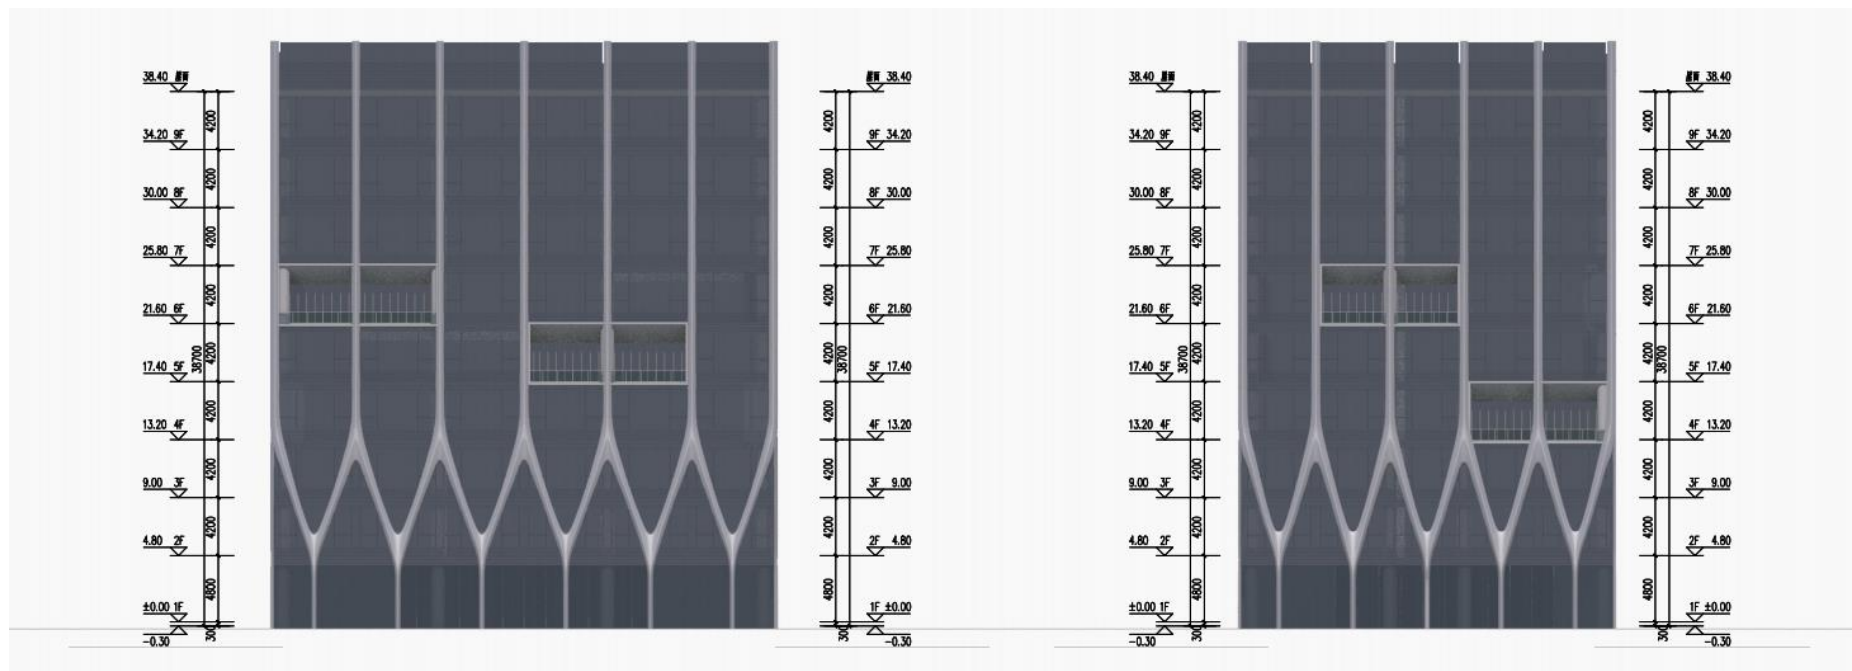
汕头农业遗传育种与生理生态重点实验室西南立面图（左）及西北立面图（右）
